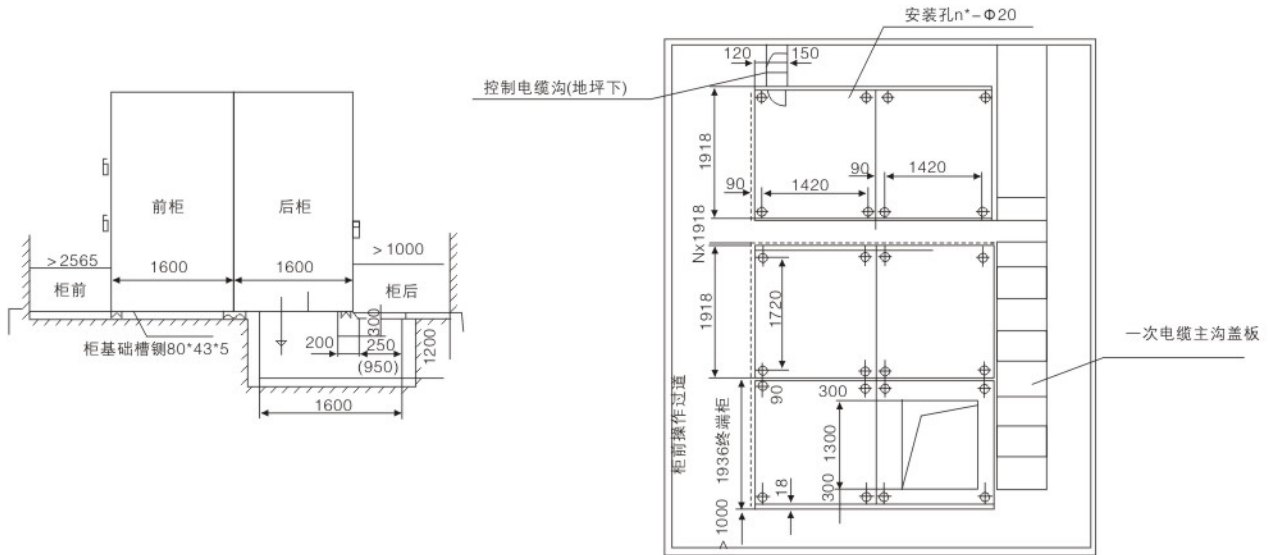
开关设备单列平面布置、基础槽钢埋放和一次电缆沟基础及二次控制电缆位置示意图
